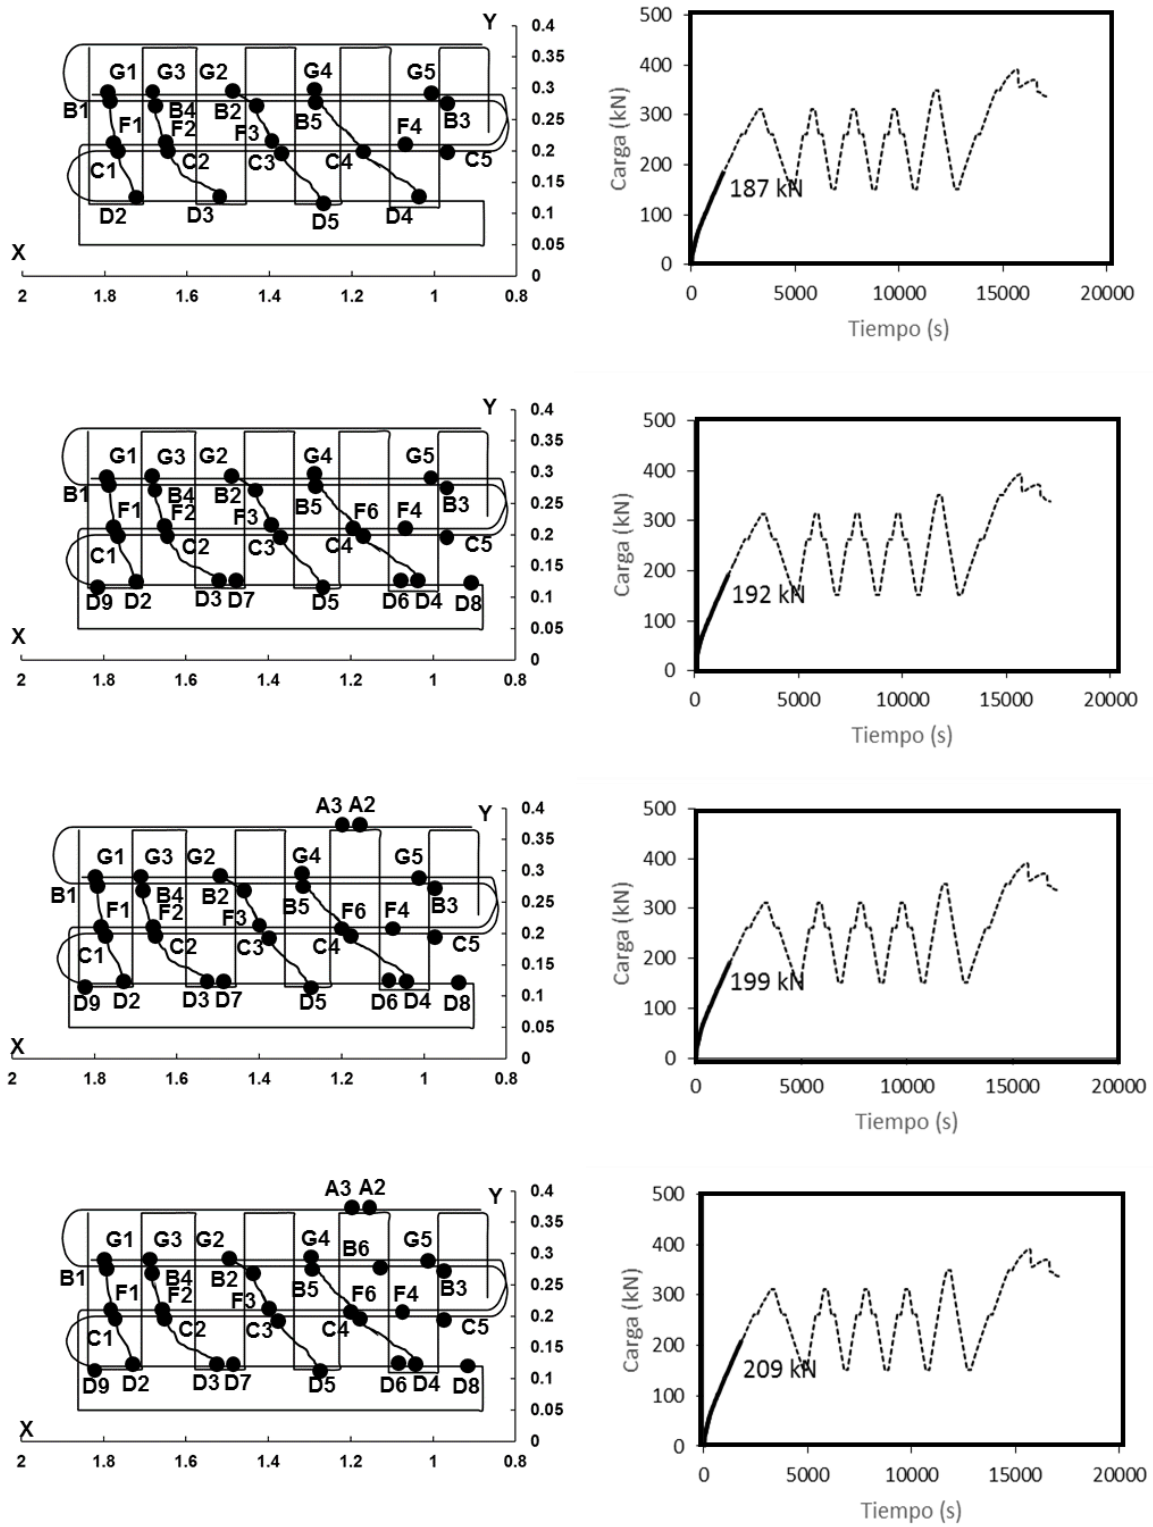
Patrones de fisuración de la viga I-1 (187 a 209 kN)
